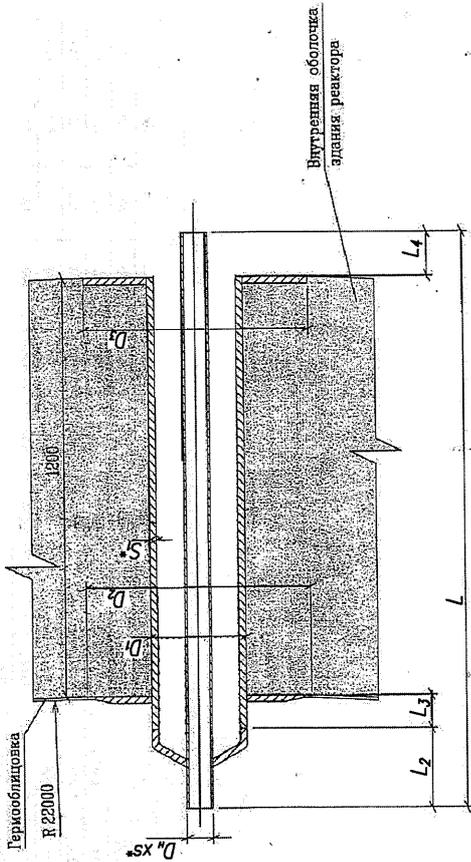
Габаритный чертеж герметичной проходки
